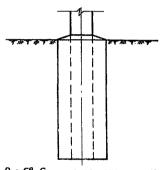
Дбухричельное закрепление опрохидываемого узкого фундамента глубокого заложения
